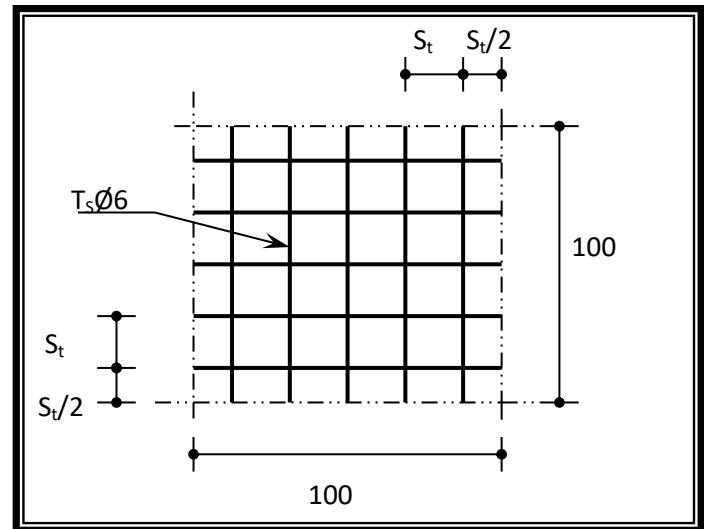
Disposition constructive des armatures de la dalle de compression
